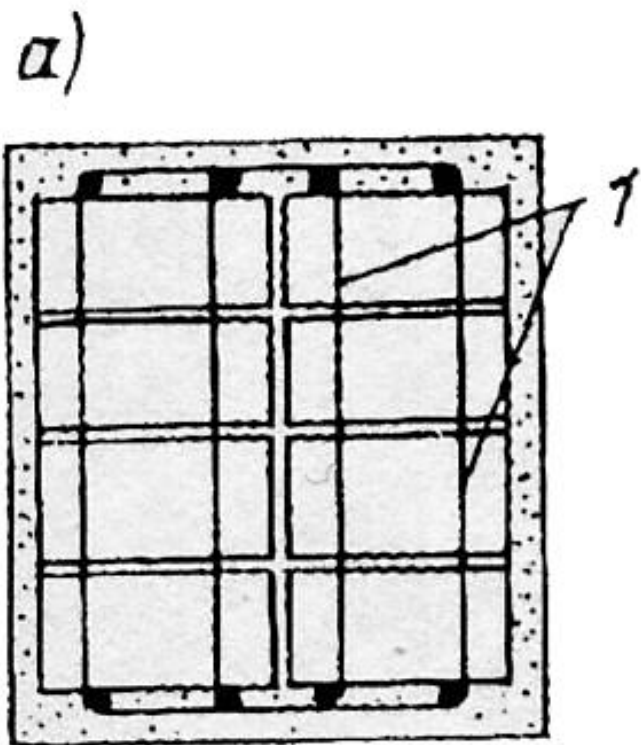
Продольное армирование кирпичных стен и столбов:
